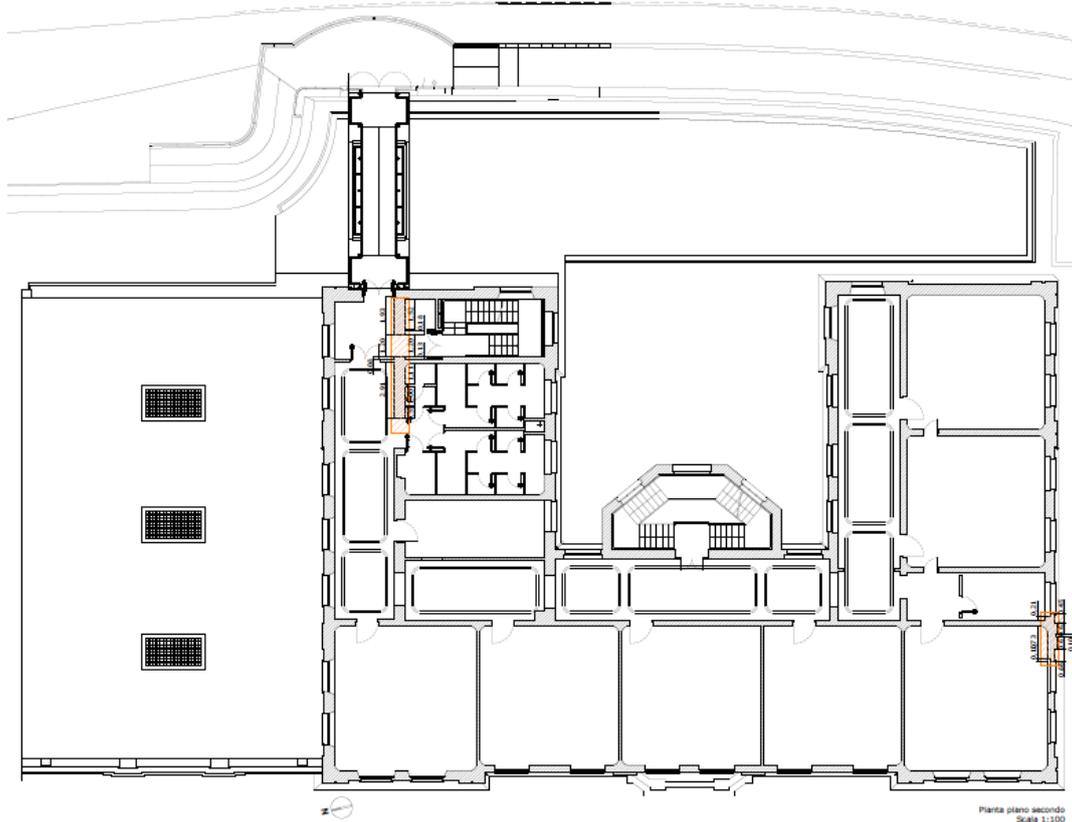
Pianta piano Secondo con indicazione delle zone di intervento
